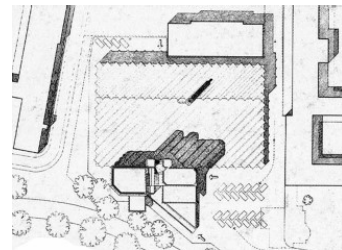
Planta de conjunto de la Escuela de Ingeniería de Leicester, Inglaterra, (1959-1963), James Stirling.
